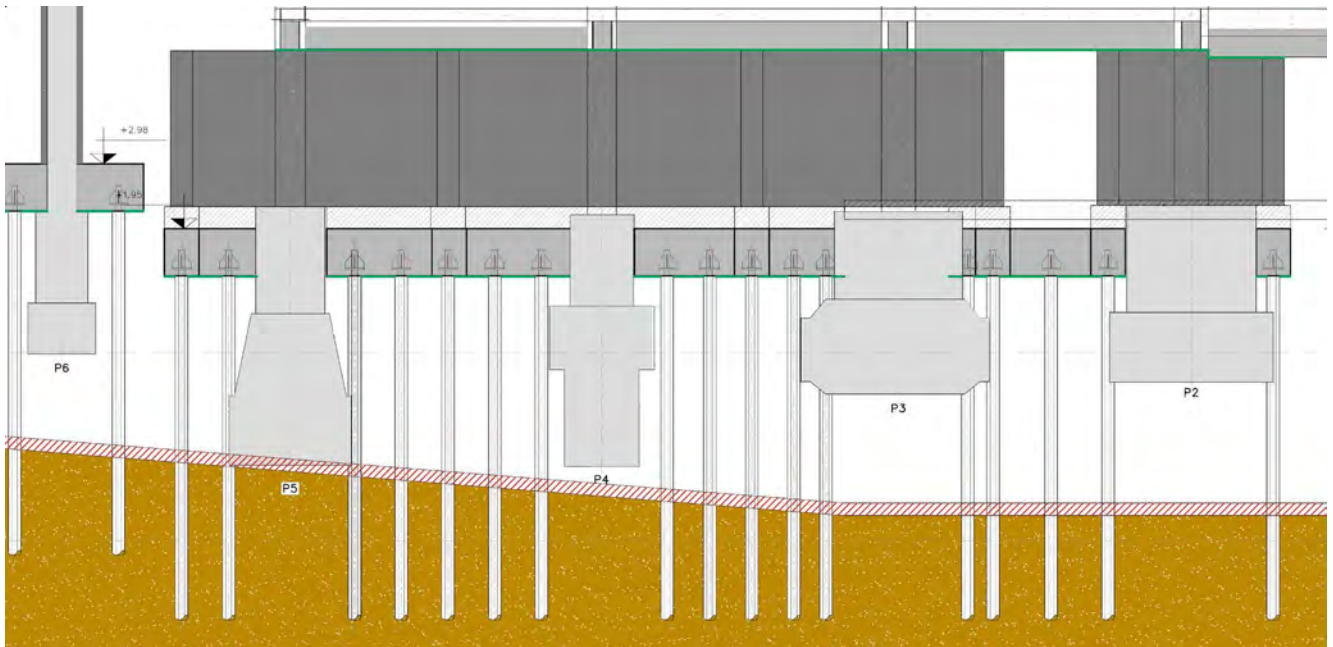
Alzado parcial del recalce de la estructura y cota inferior del túnel de carros.
